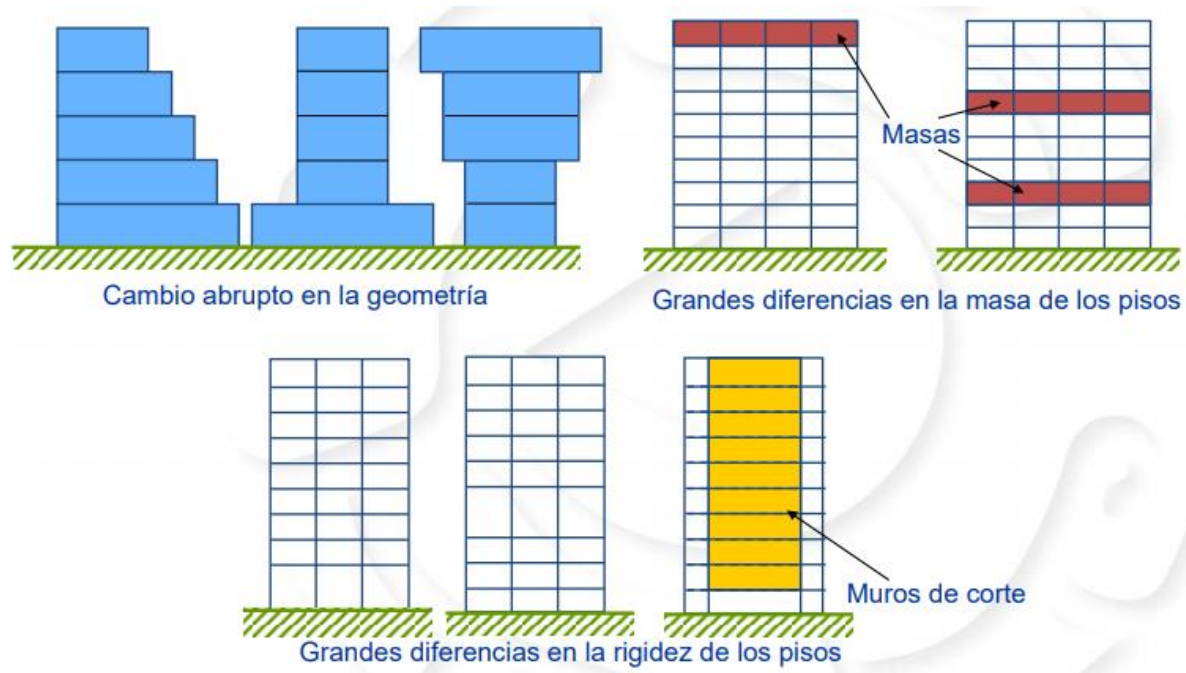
Ejemplos de estructuras con irregularidad en elevación. (CENAPRED, 2016)
